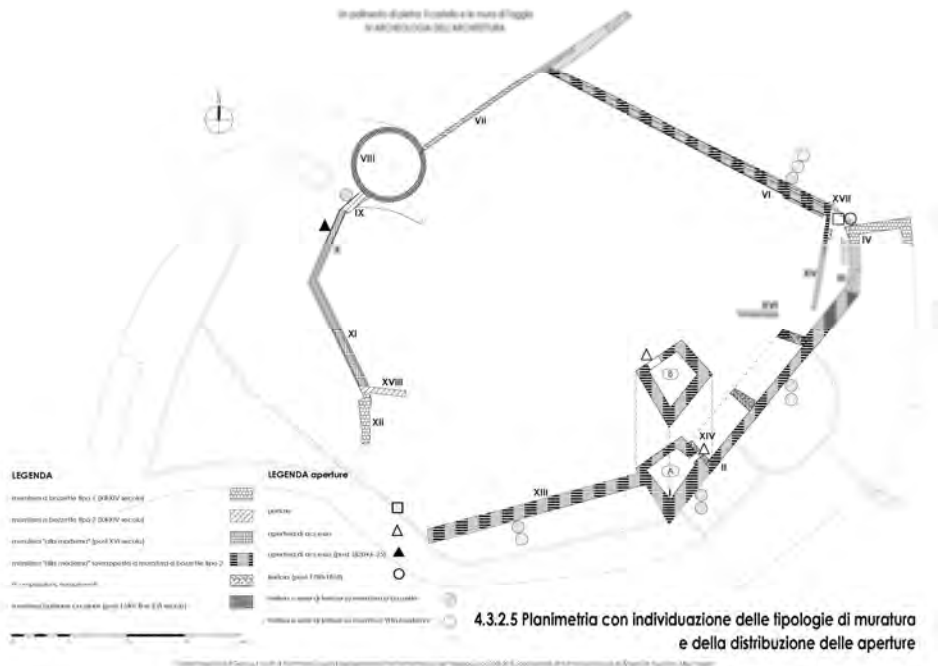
Planimetria con individuazione delle tipologie di murature e della distribuzione delle aperture.
